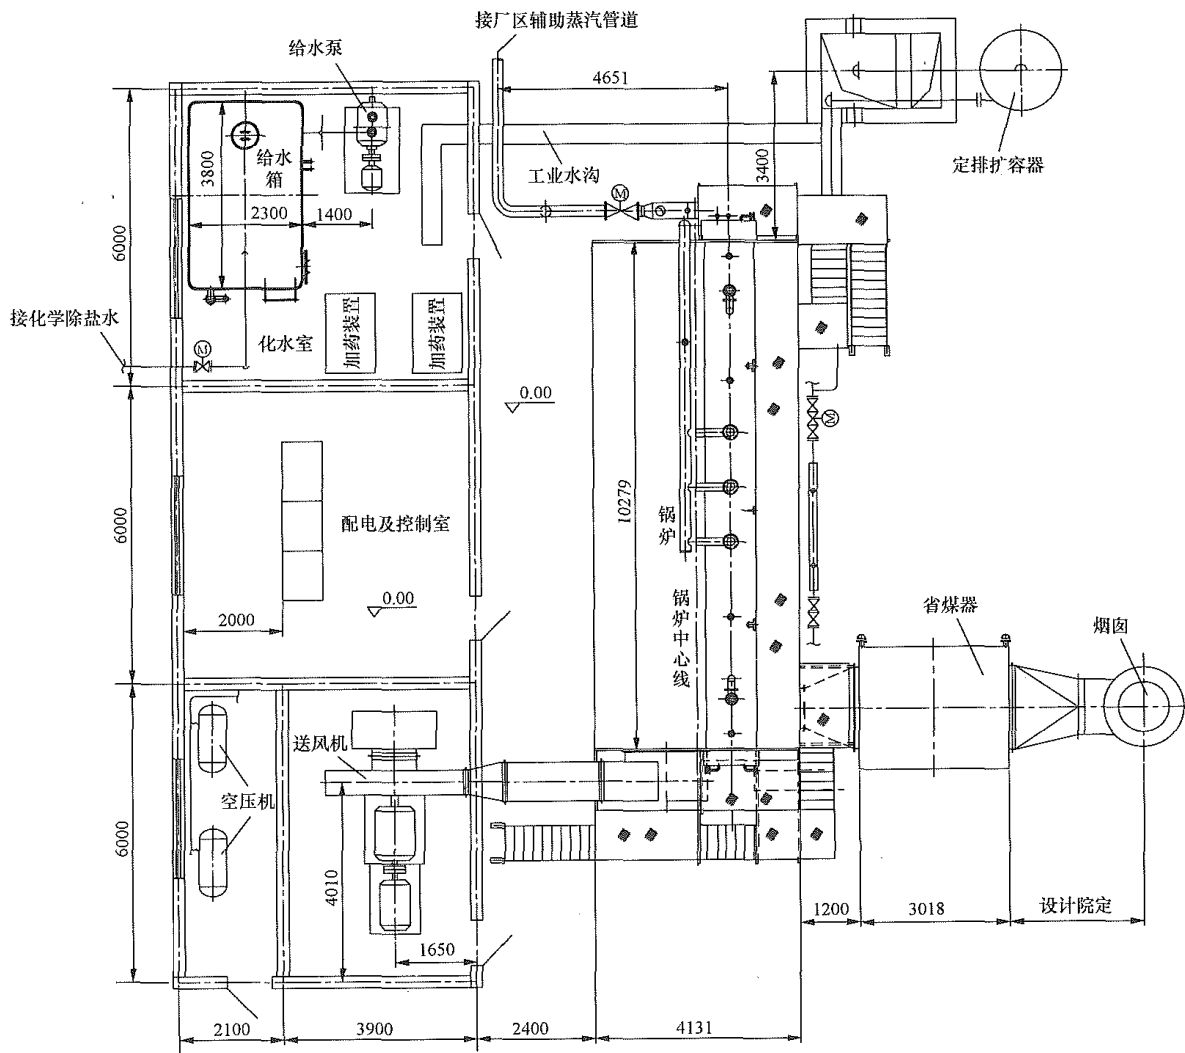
40t/h 燃油、燃气辅助锅炉房平面布置图（露天布置方案）
